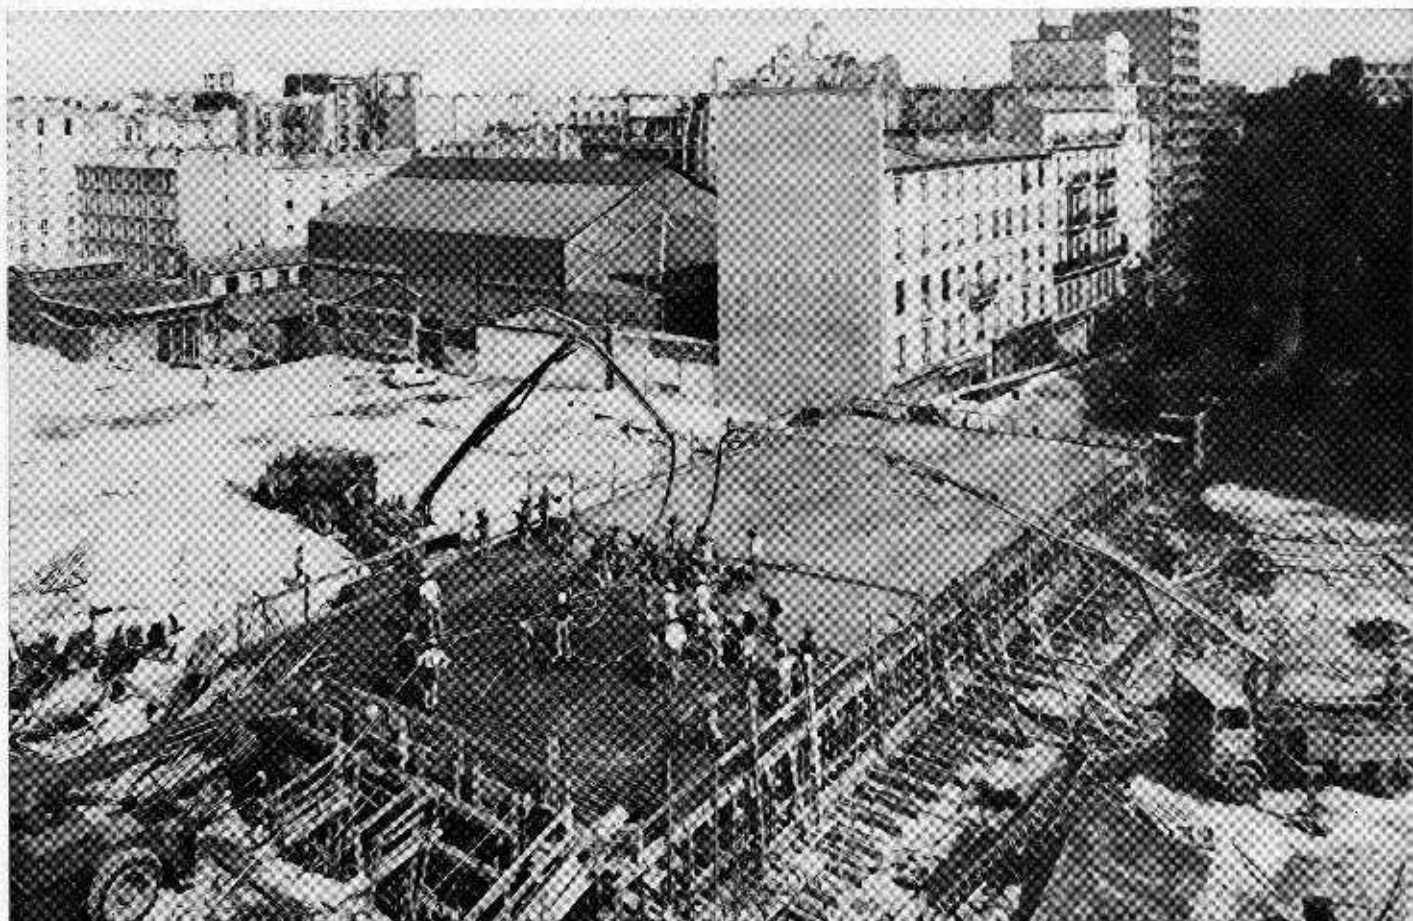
Chantier de construction de l'ouvrage d'allongement de la rue de Jessaint. L'ouvrage actuel de franchissement de la tranchée est à gauche en dehors de la photo. (Photo Billerach).
